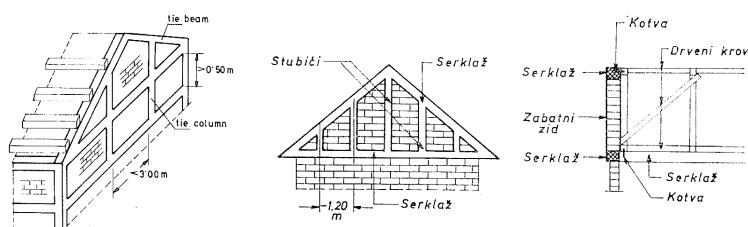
Pravilno povezivanje krovne konstrukcije i serklaža
